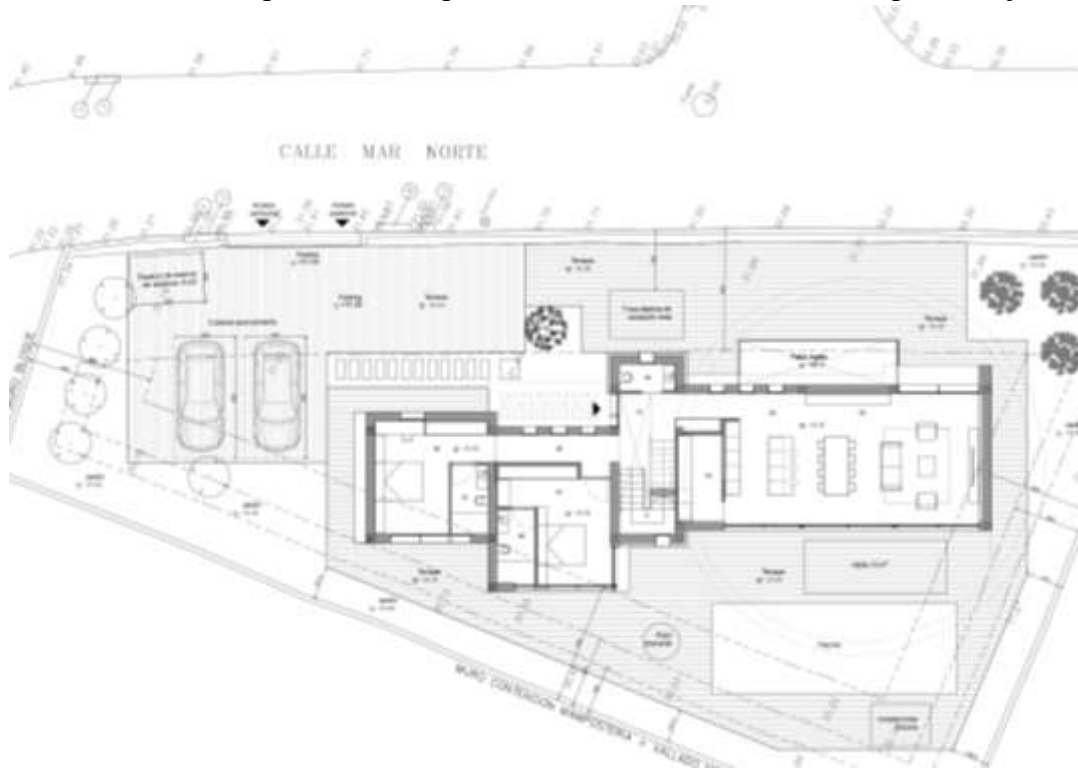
Planta baja. Fuente: proyecto básico y de ejecución.
